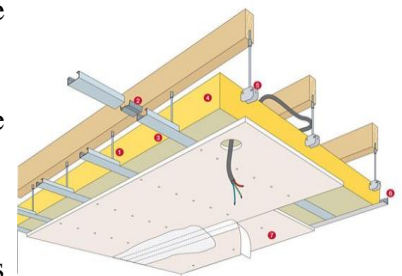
Composantes d'un faux Plafond suspendu.<sup>120</sup>
